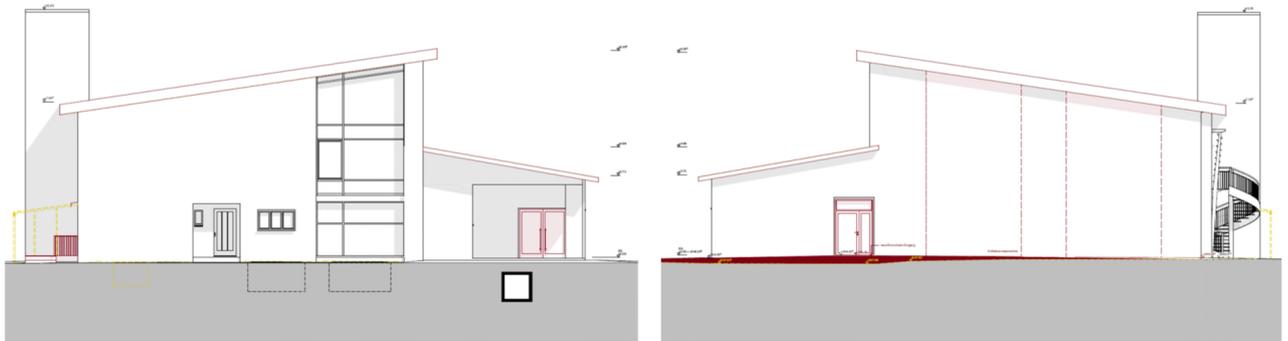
Hallenrakt – Südostfassade und Nordwestfassade
